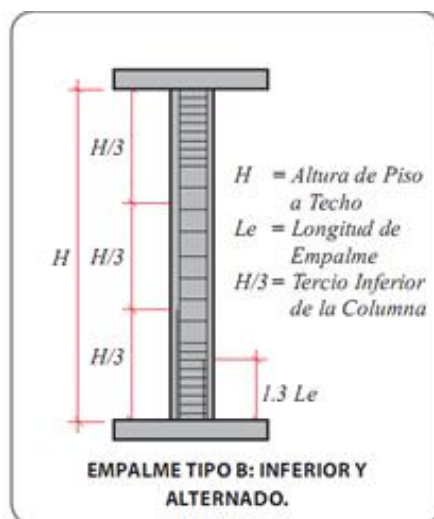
Longitud de Empalme Tipo B
